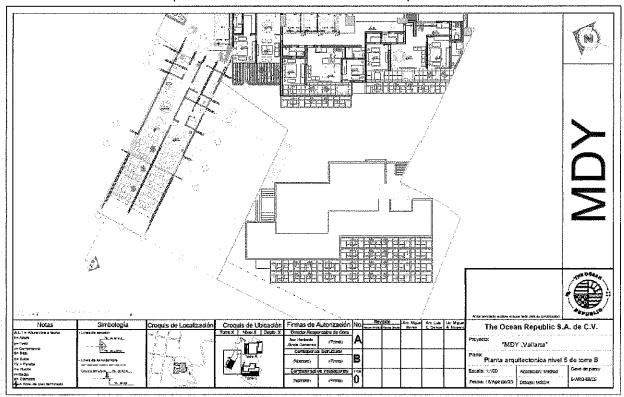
Planta arquitectónica nivel 5 de torre B
